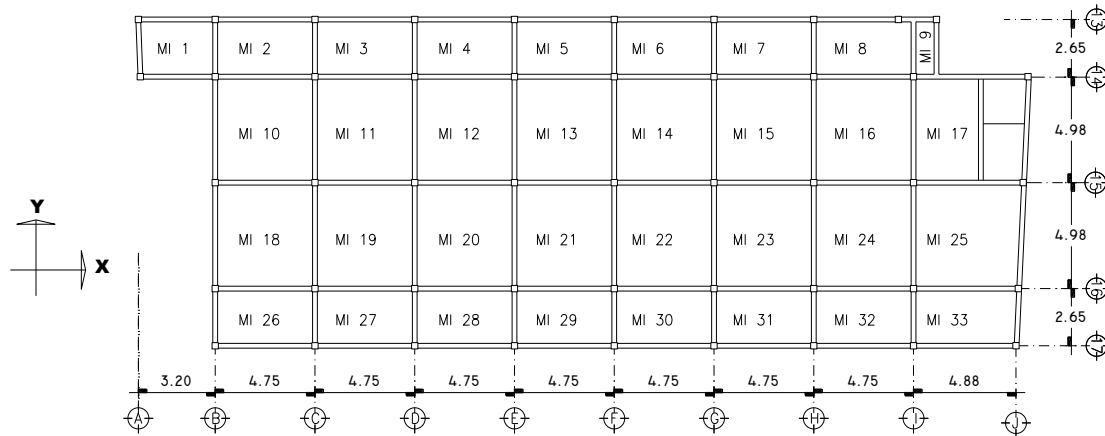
Planta distribución de losas, primer nivel y segundo nivel, módulo IIA y III
